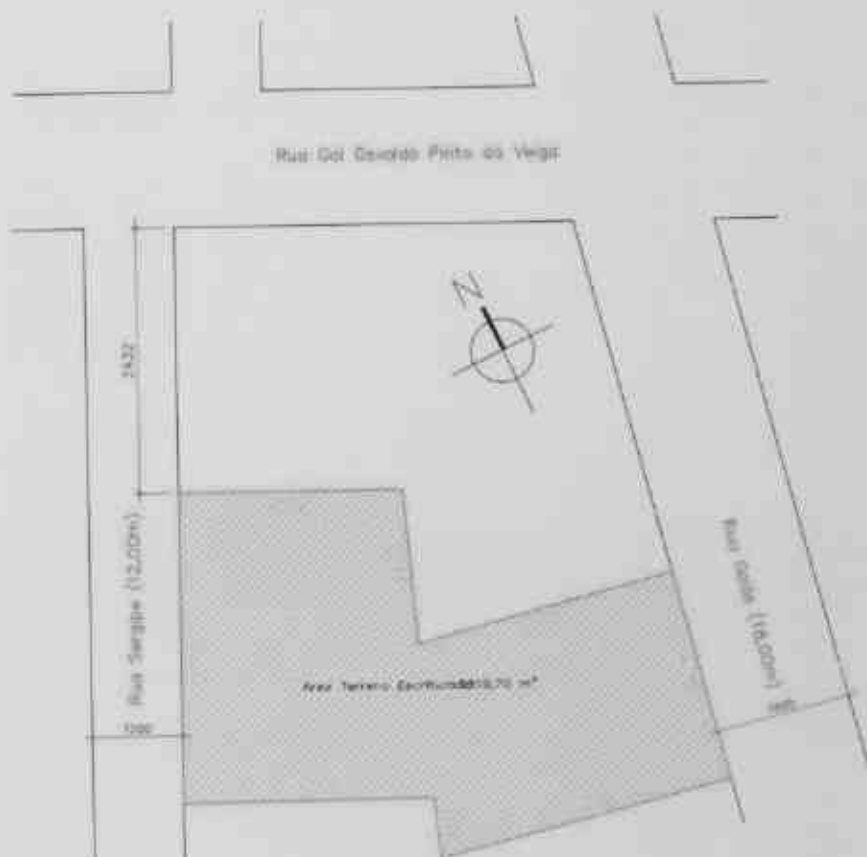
Planta de situação. Fonte: Projeto arquitetônico.
